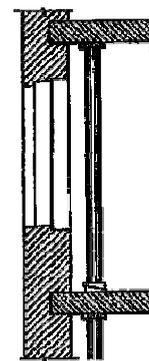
Вывешивание балок перекрытия, опирающихся на перекладываемый простенок
